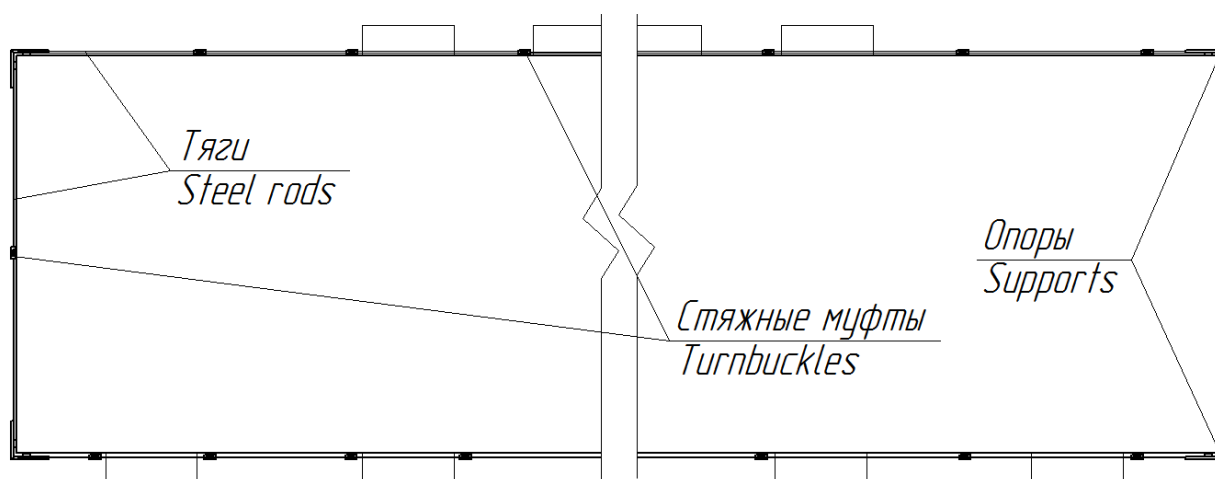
Схема расположения элементов усиления надфундаментной части здания ниже карнизных плит
